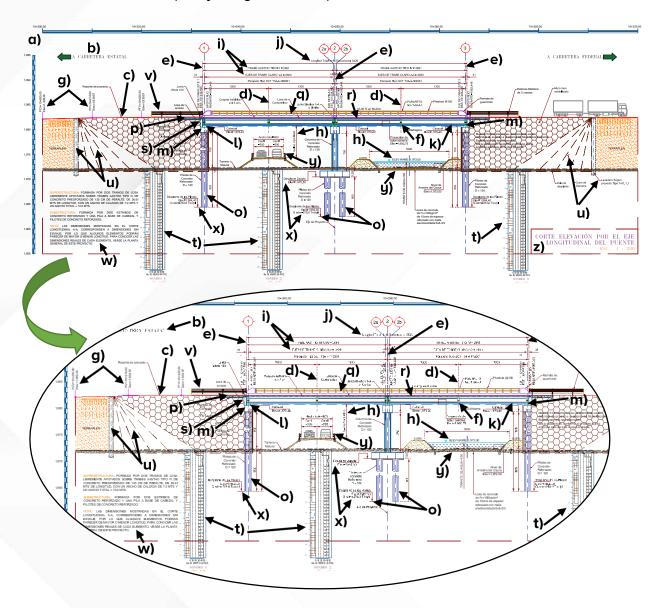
Ejemplo corte elevación por eje longitudinal del puente
